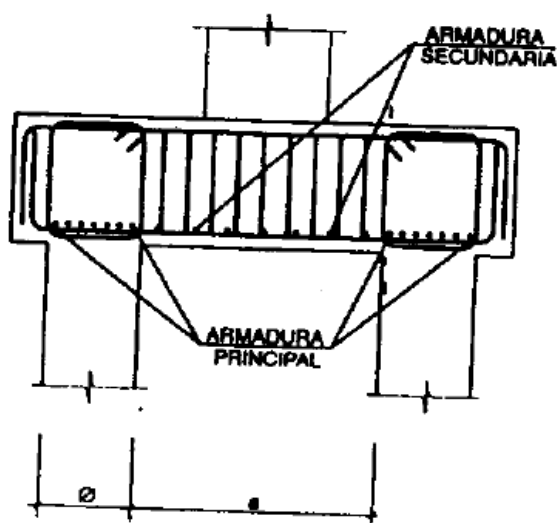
Armaduras del cabezal de un grupo de tres y cuatro pilotes.
